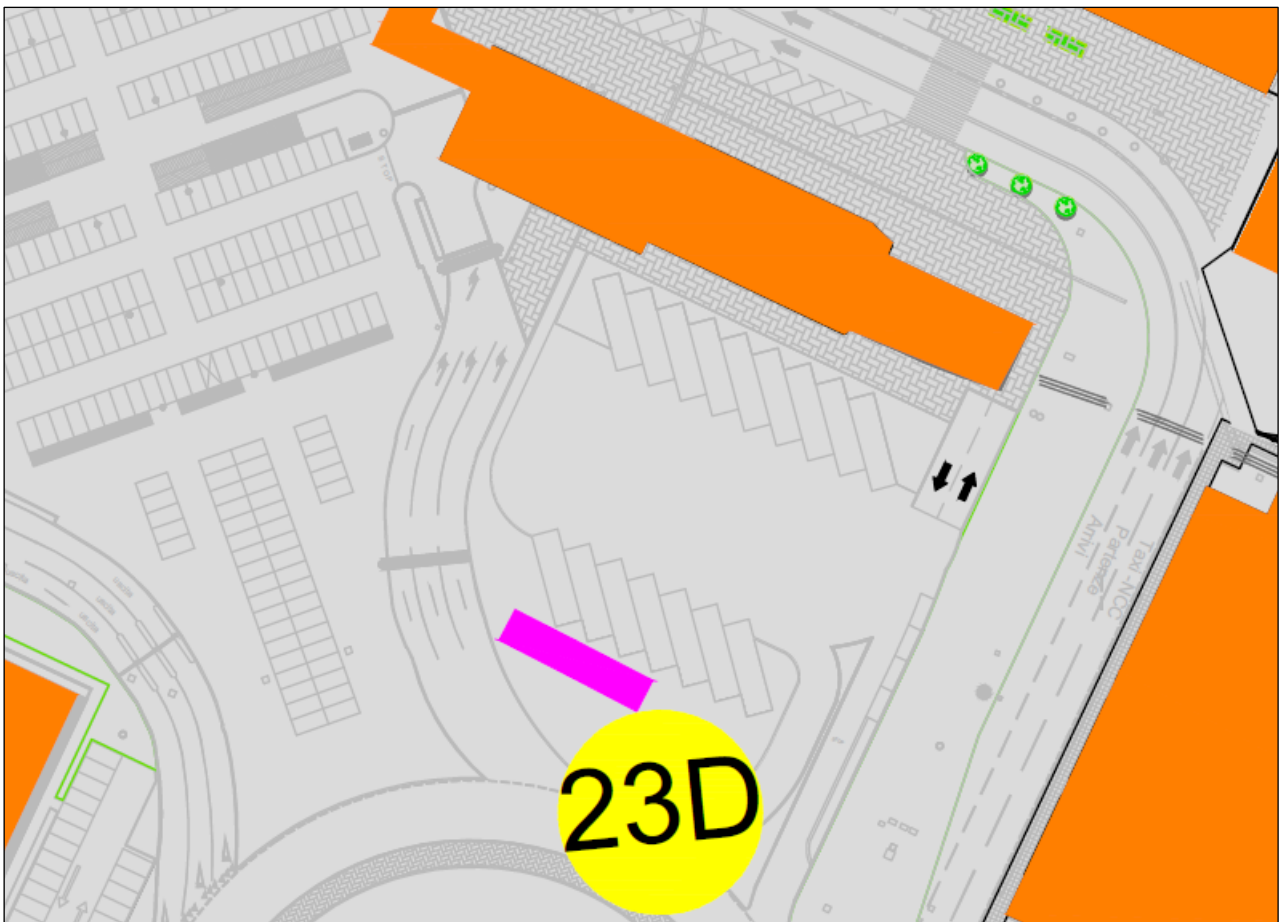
Estratto Master Plan – Spostamento Cabina Subconcessionari
